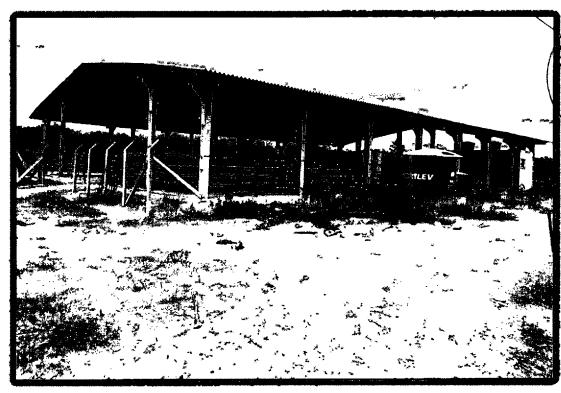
Galpão da Bovinocultura. Estrutura de concreto, telhado de fibrocimento e pilares. Fonte: PROAD/PROPLA/UFERSA. Foto tirada em agosto de 2019.
